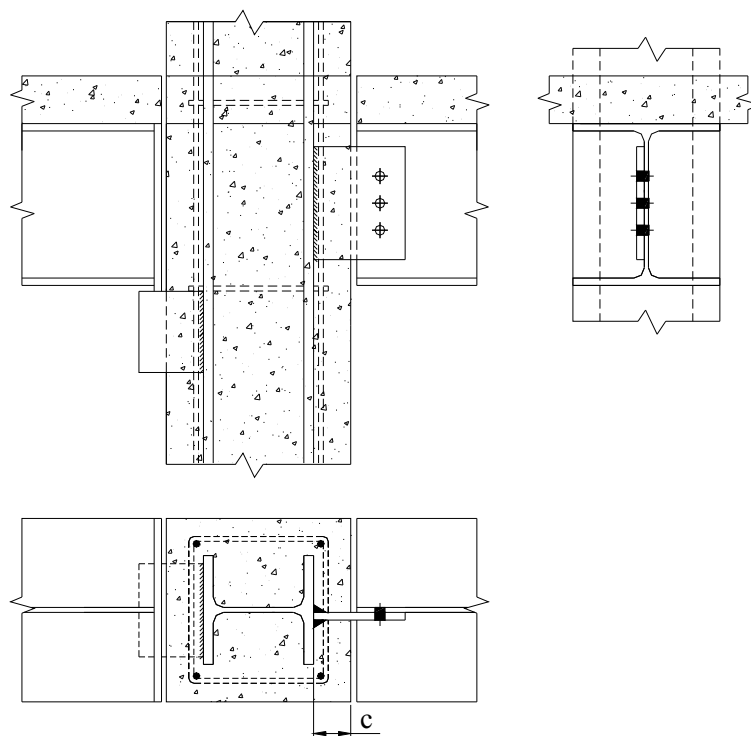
Exemplos de ligação entre viga e pilar misto totalmente revestido por concreto
